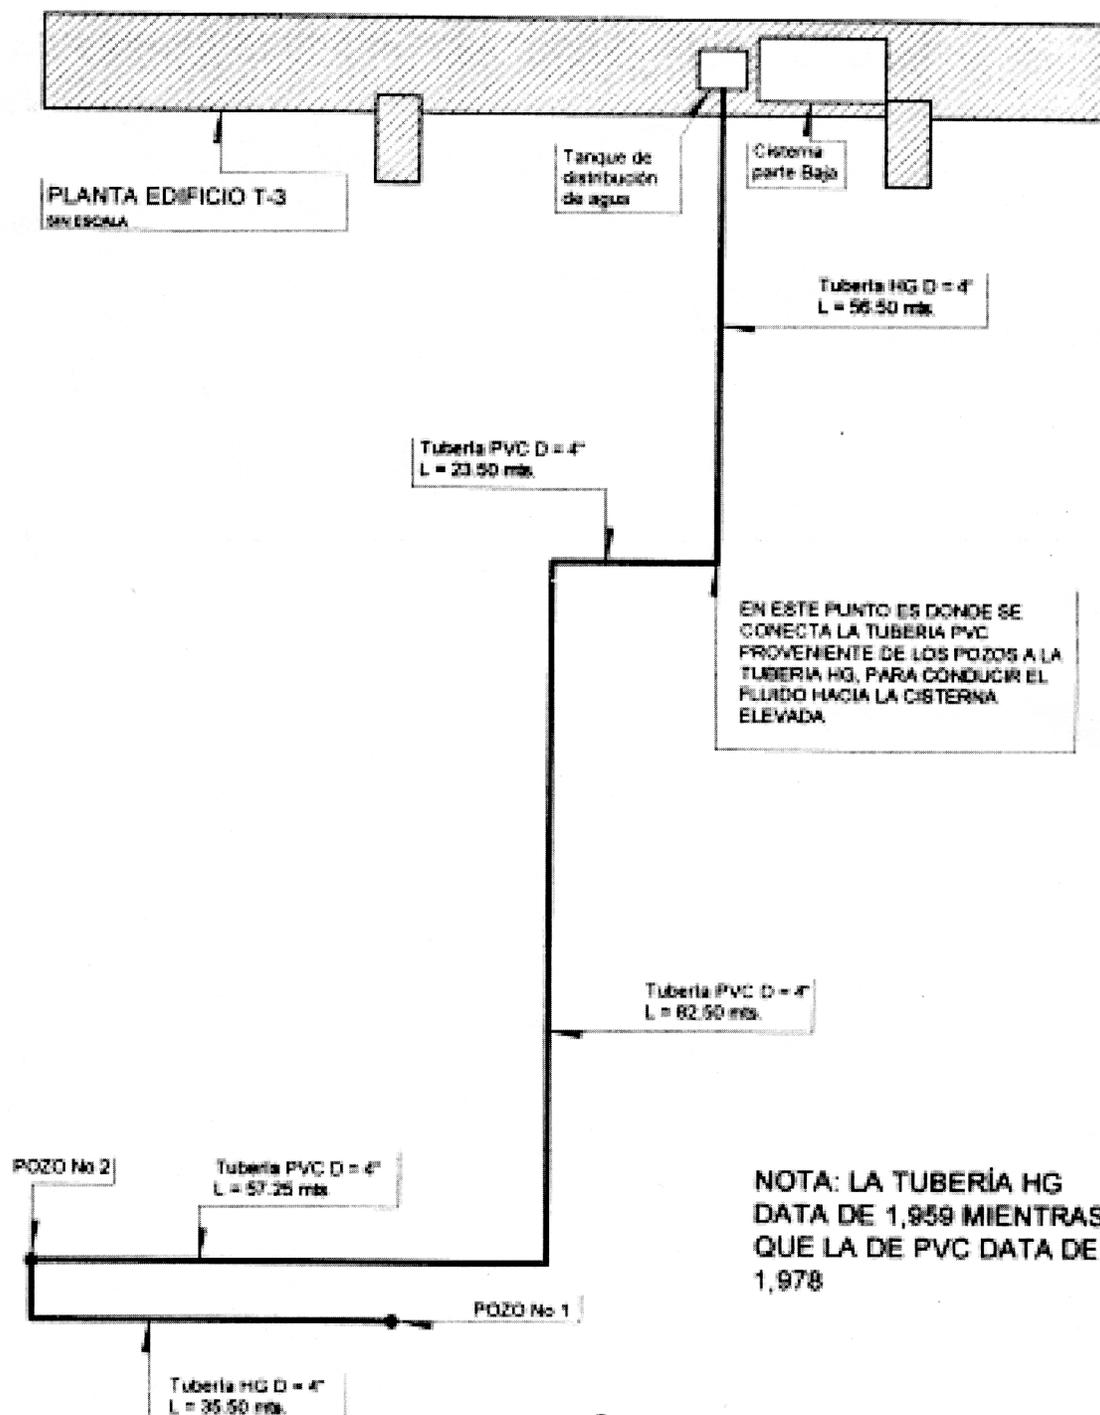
Planta de línea de conducción de pozos a tanque elevado
